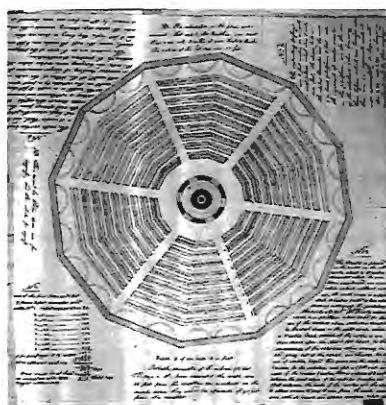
Planta de School house – desenhada por Jeremy Bentham, 1816.
